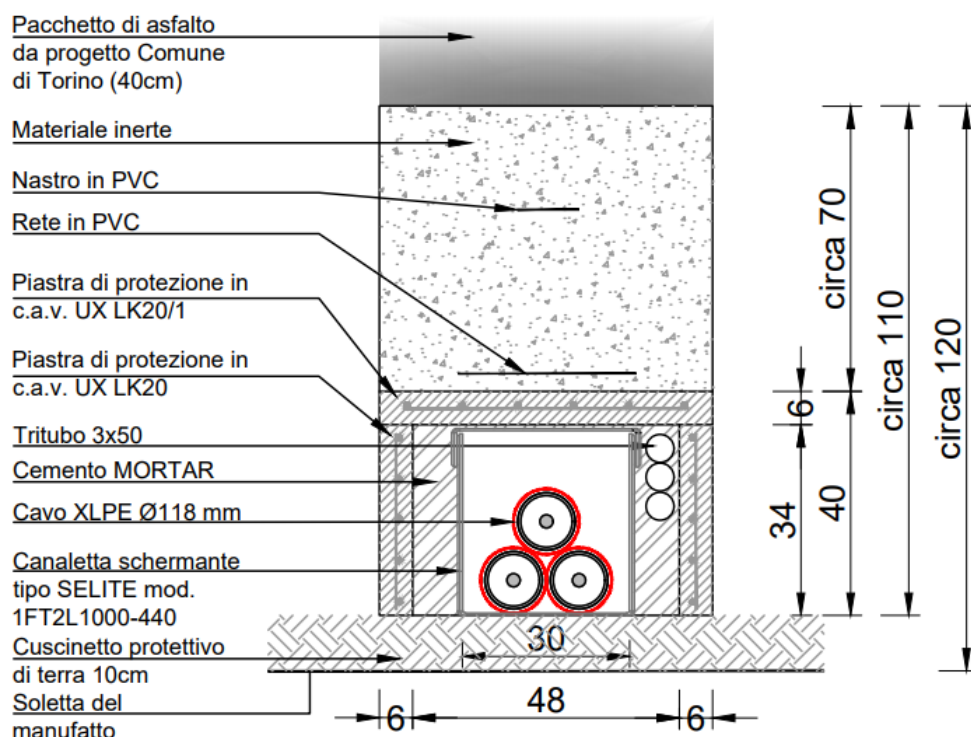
T 294 – Sezione tipo lungo passante ferroviario (Fonte: Terna)
